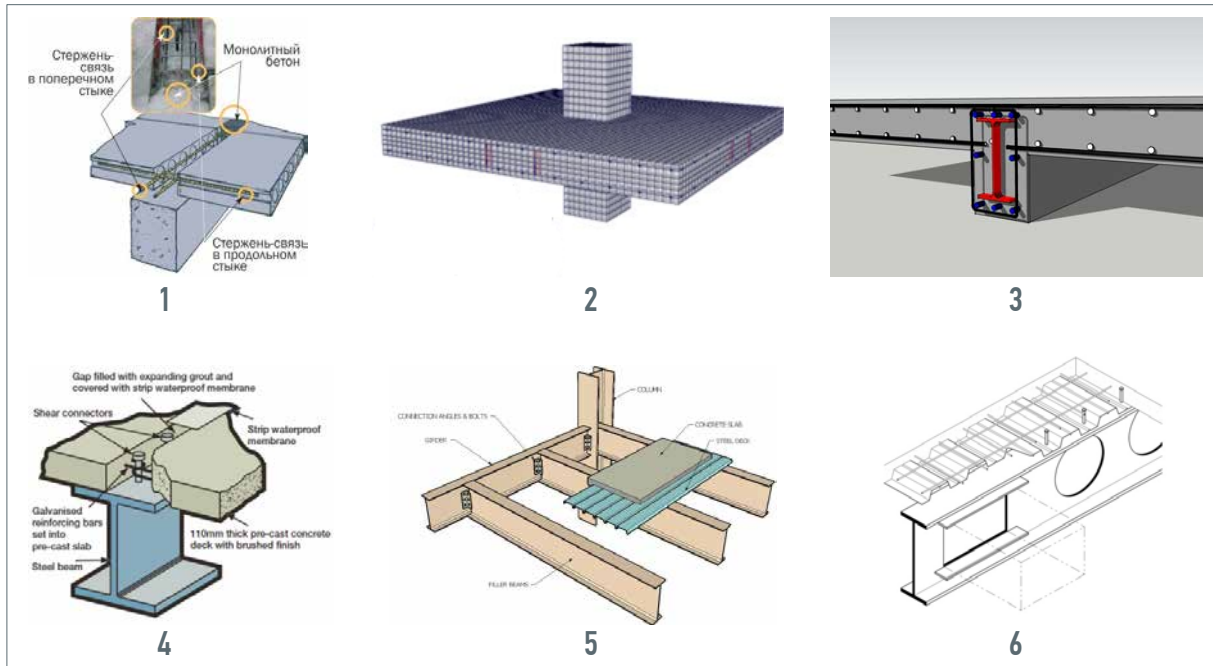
Вузли конструктивних вирішень перекриттів: 1 – залізобетонне збірне; 2 – монолітне безригельне; 3 – монолітне ребристе з жорсткою арматурою; 4 – сталеві балки зі збірними залізобетонними плитами; 5 – сталеві балки з монолітними плитами по профнастилу; 6 – композитні перфоровані балками із монолітними плитами по профнастилу
